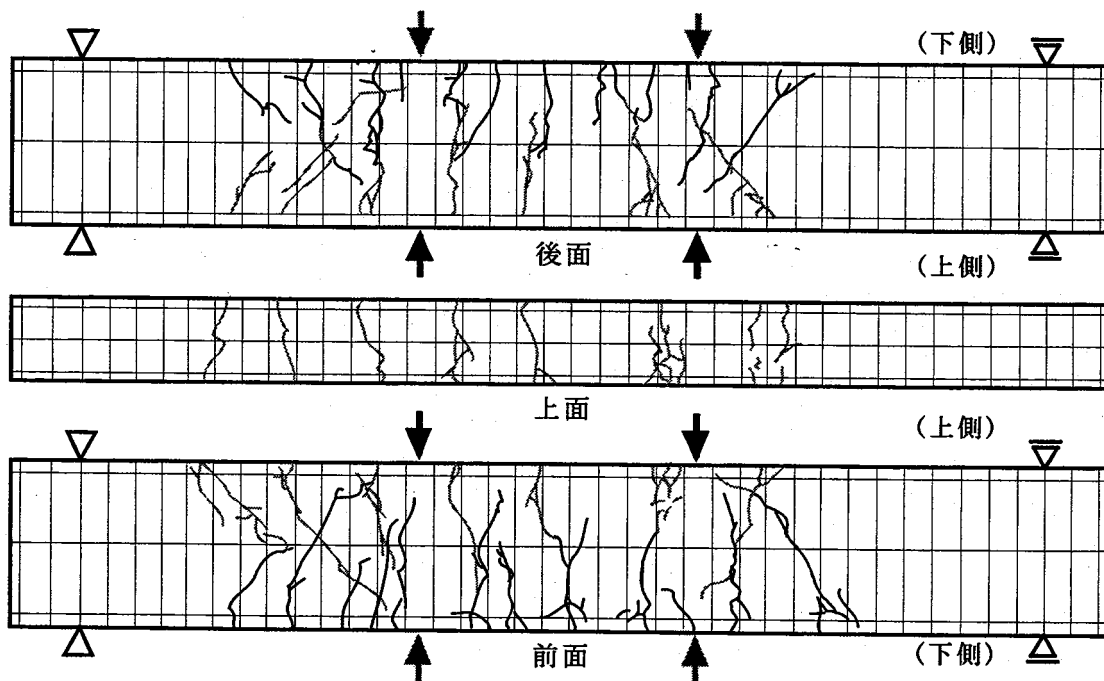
e) ひび割れ性状 [BS-4 ; R = 1/100rad.]
